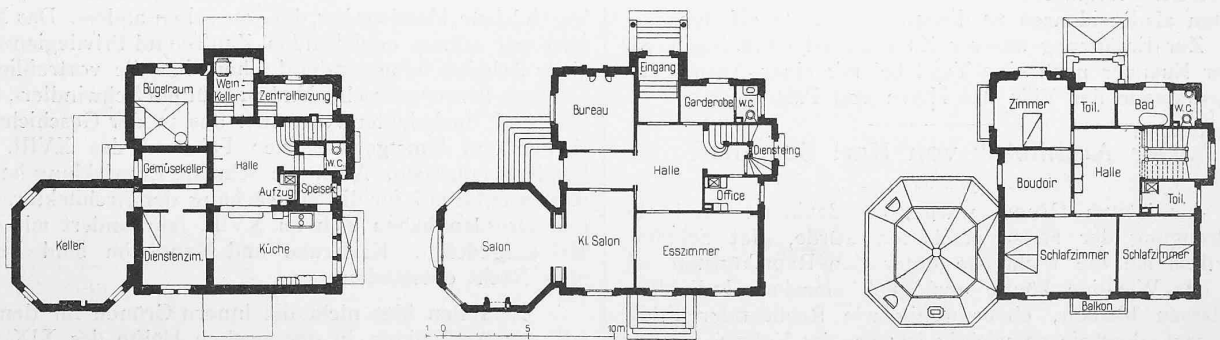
, 13, 14. Grundrisse vom Keller, Erdgeschoss und ersten Stock der italienischen Gesandtschaftsvilla. — 1:400.
